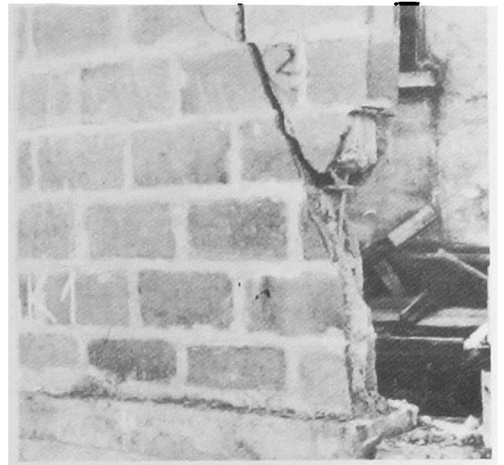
Muro B 3a de 20, detalle grieta.
